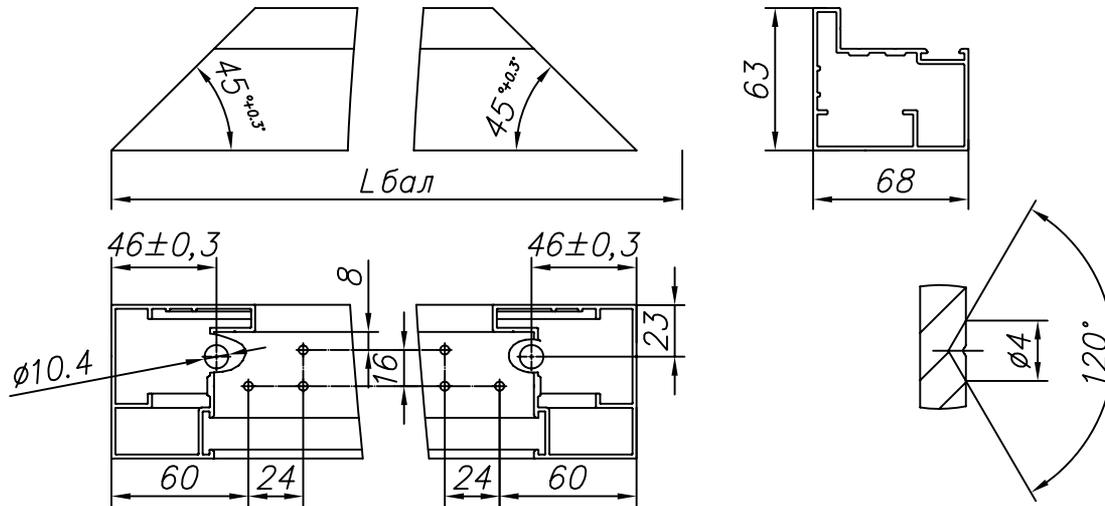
Изготовление верхней балки (калитка без перекладины)
